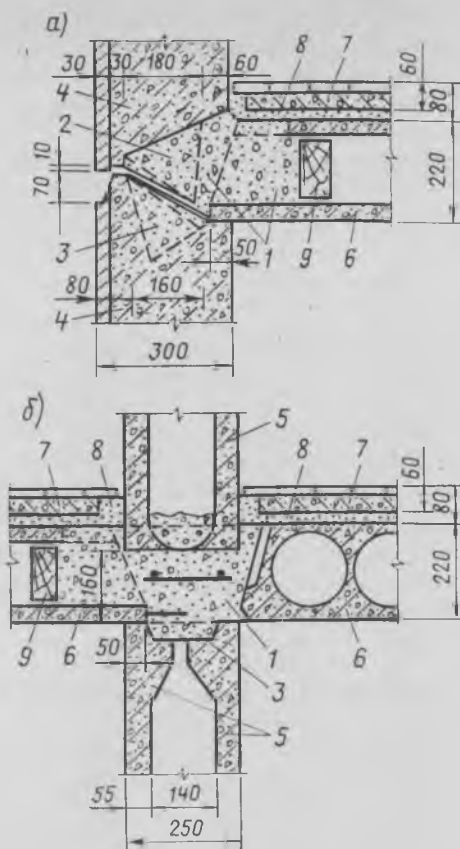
Стыки панелей наружных (а) и внутренних (б) стен и перекрытий
